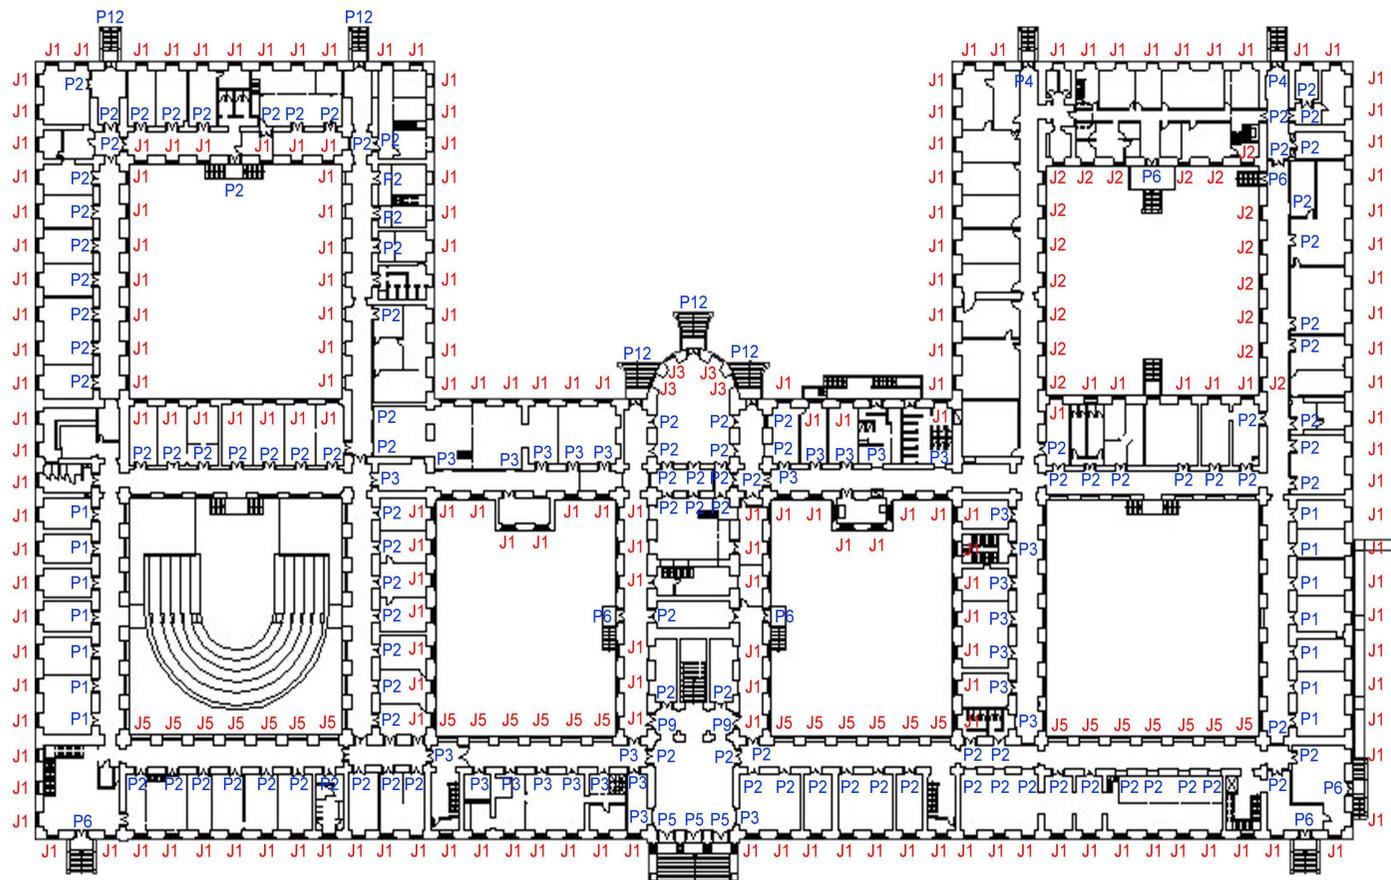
Planta de localização das portas e janelas do térreo.
